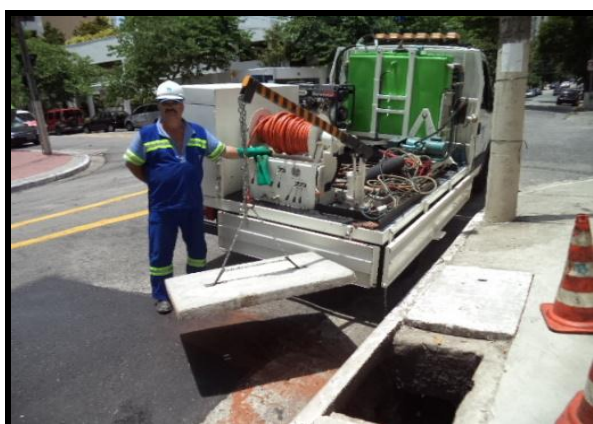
UDE – Equipamento para levantamento de tampas de concreto
